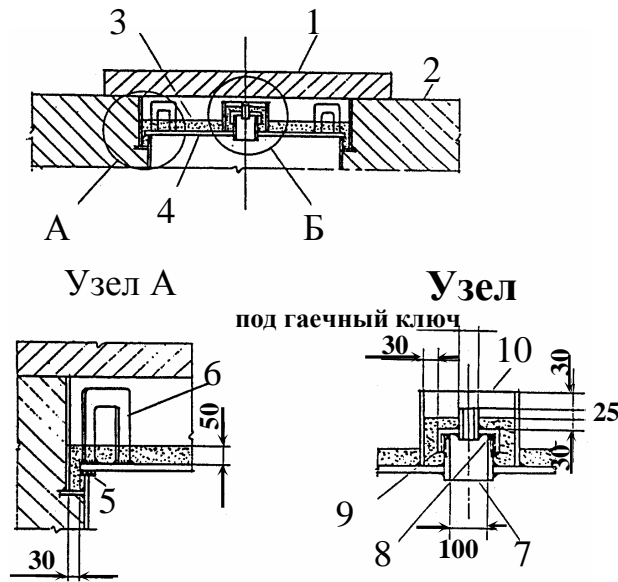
Люк для дозасыпки ствола: 1 – железобетонная плита (не менее 500 кг); 2 – полок перекрытия устья ствола; 3 – асфальтовая мастика (толщина слоя не менее 50 мм); 4 – крышка люка (сталь Ст. 3, толщиной 16–20 мм); 5 – прокладка из конвейерной ленты; 6 – подъемная петля; 7 – патрубок для контроля уровня закладки ствола; 8 – уплотнение из резины; 9 – пробка патрубка; 10 – гильза (размеры в мм)
